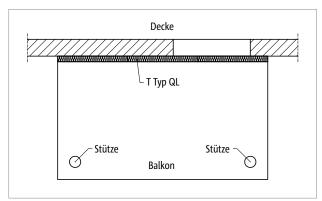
Schöck Isokorb® T Typ QL: Balkon mit Stützenlagerung
